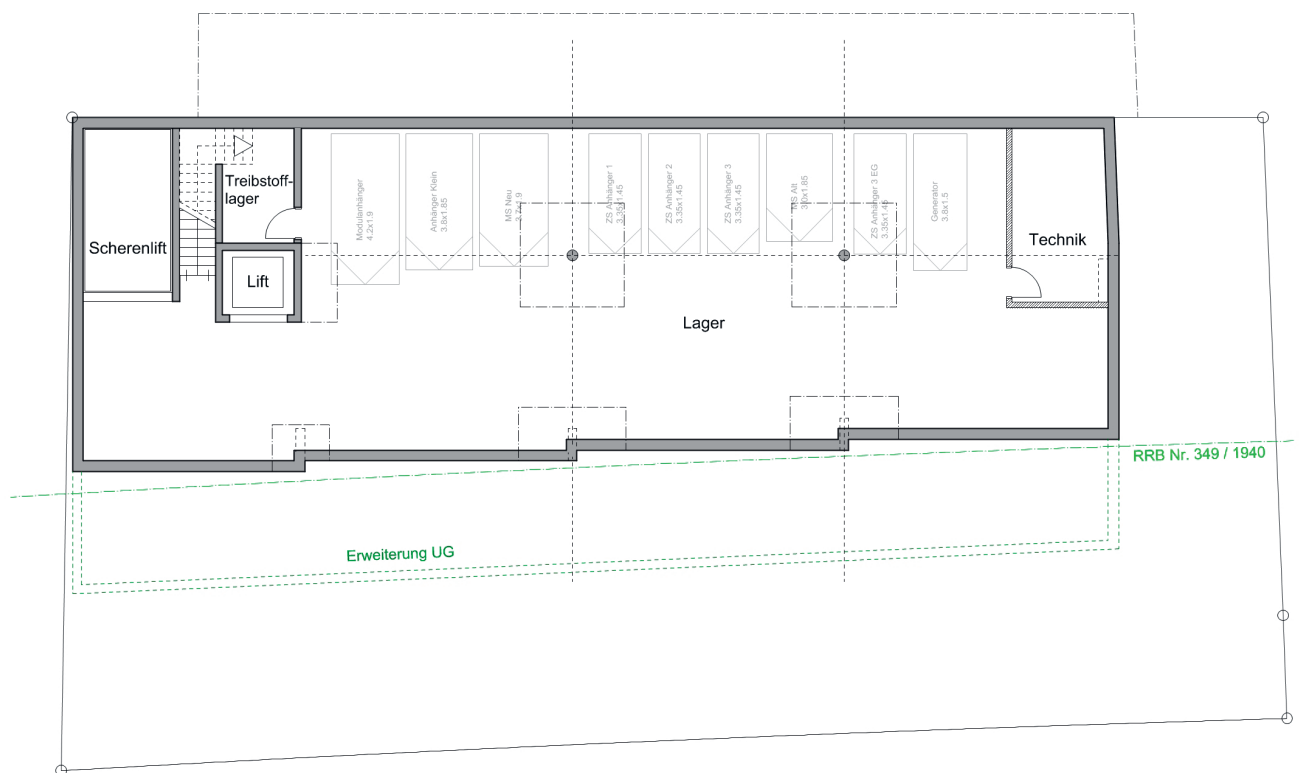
Grundriss Untergeschoss (Lagerflächen)
